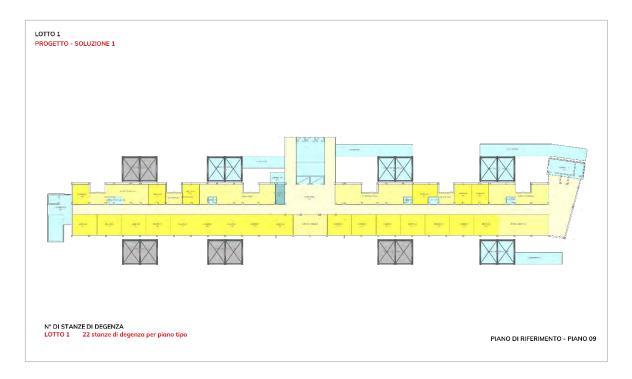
PROGETTO PIANO TIPO LOTTO 1 - SOLUZIONE 1
